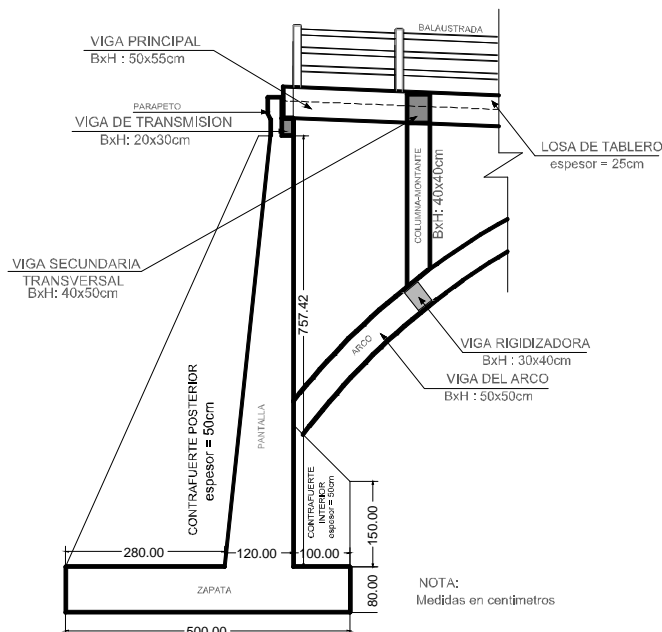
Secciones de prediseño del estribo, pórtico y tablero. AUTOR Pedro Hurtado L.
